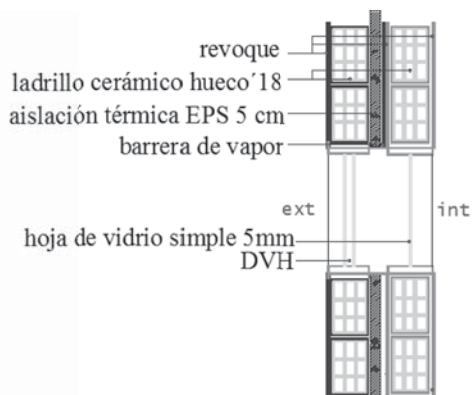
B. Detalle del muro exterior con aislamiento térmico y carpintería DVH.
